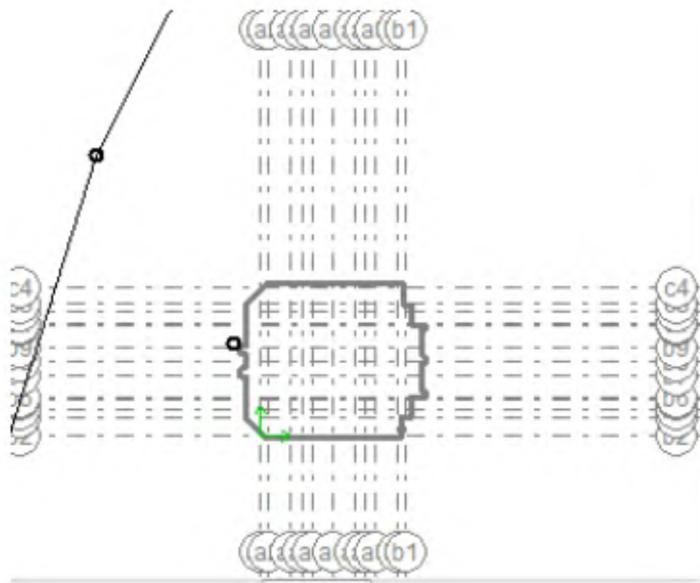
Стикування будівлі з моделлю ґрунту.
